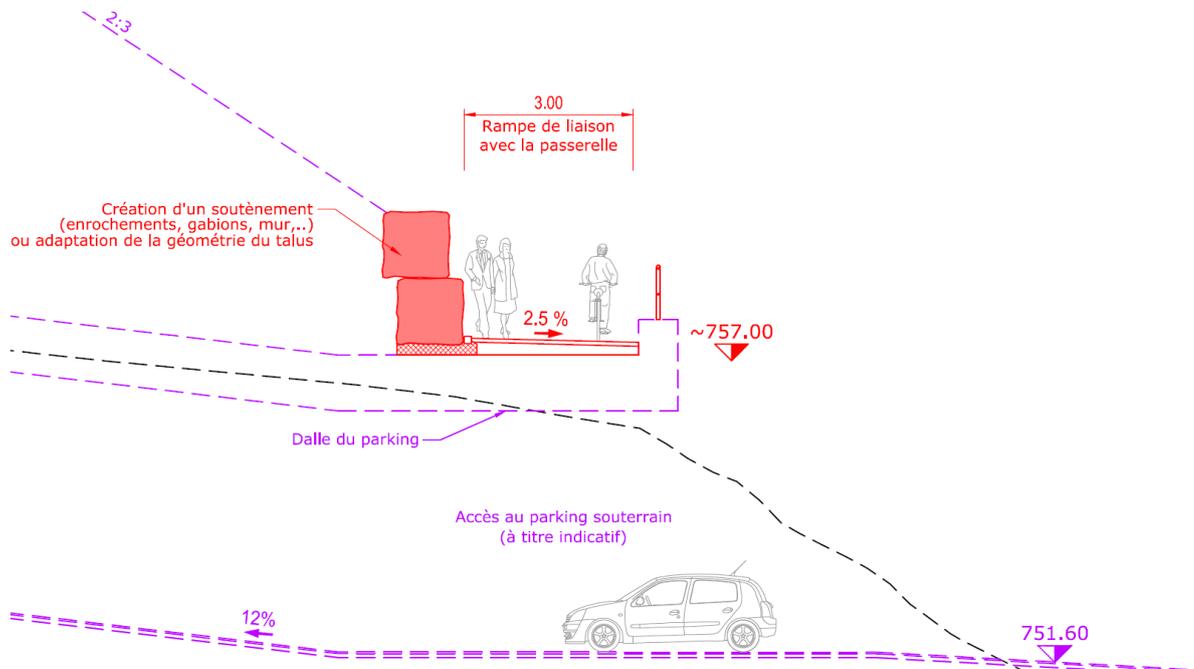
Profil en travers (coupe A-A) de la rampe avec le passage au-dessus de la dalle du parking, avec mur de soutènement à l'amont pour soutenir la butte.
